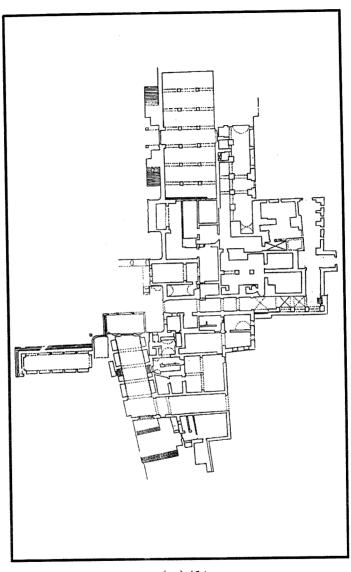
مسجد محمد على - مسقط افقى عن مركز تسجيل الآثار
